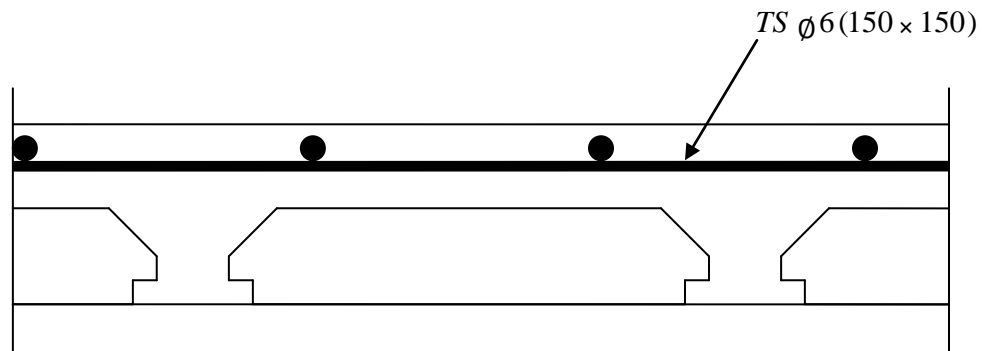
Schéma de ferrailage de la dalle de compression
